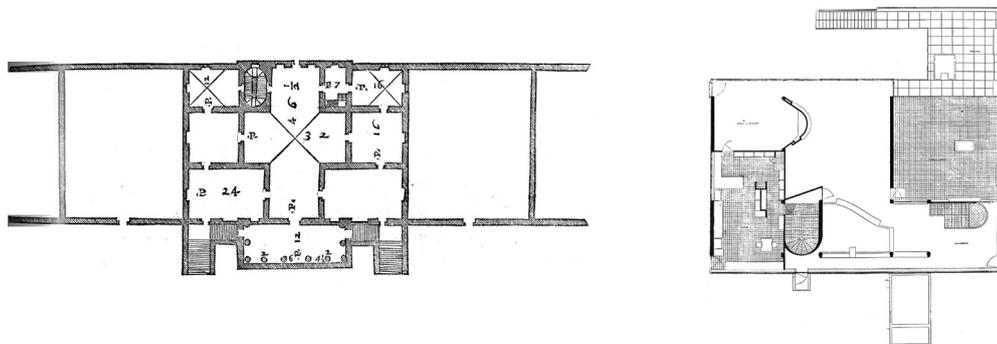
アンドレア・パツラーディオ《ヴィラ・マルコンテンタ》平面図 図1-3b 《ガルシュ邸》2階平面図
